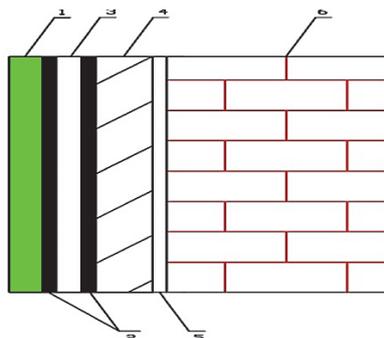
Принципиальная схема наружной теплоизоляции фасада здания «мокрого типа»
